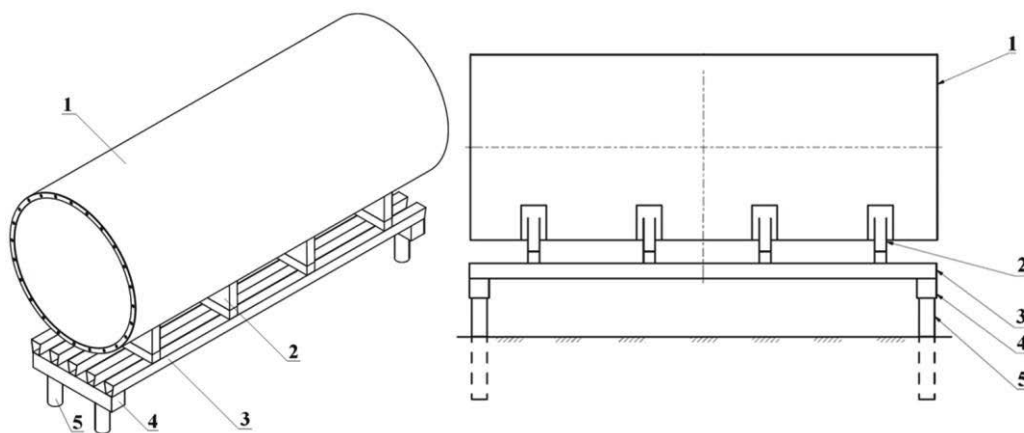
Способ компоновки основной строительной ячейки вакуумного трубопровода ВЛКЛ. 1 – вакуумный трубопровод; 2 – опора вакуумного трубопровода; 3 – продольные балки либо ортотропная плита; 4 – ригель; 5 – сваи.
